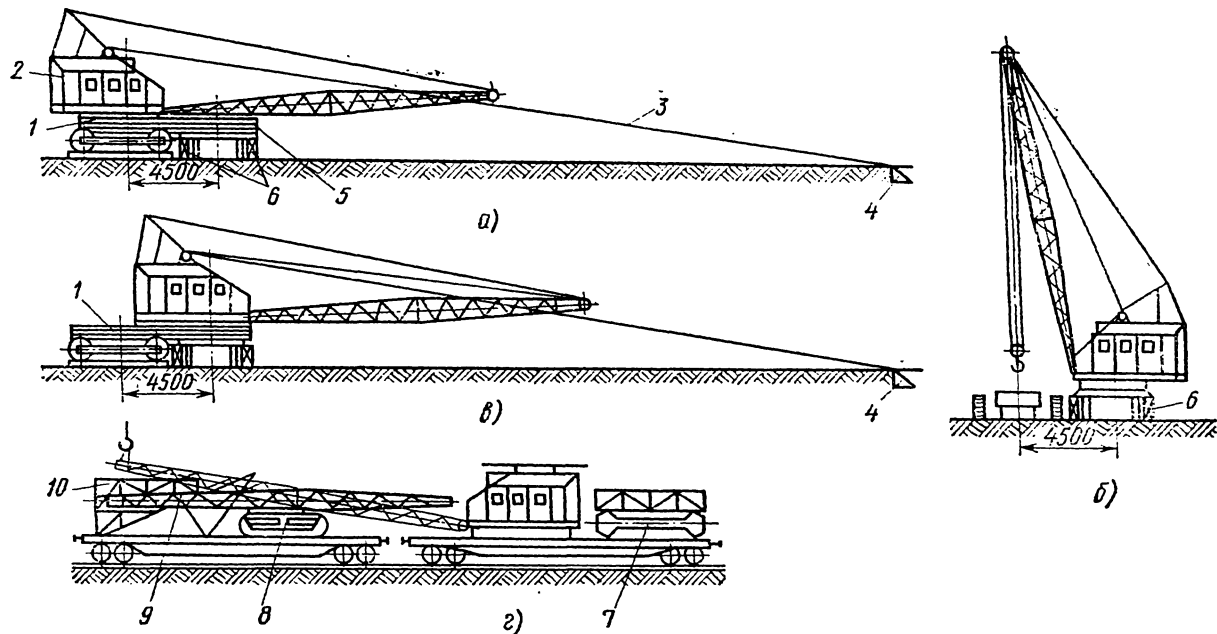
Схемы демонтажа, погрузки и перевозки гусеничного крана СКГ-40А:
